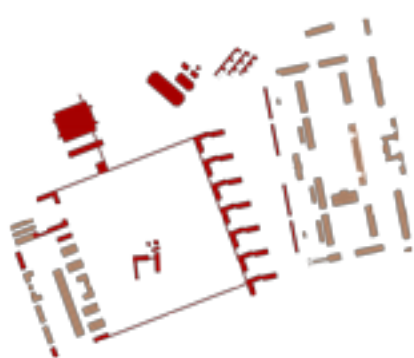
Nuovo assetto planimetrico dell'ex area Piazza d'Armi.
